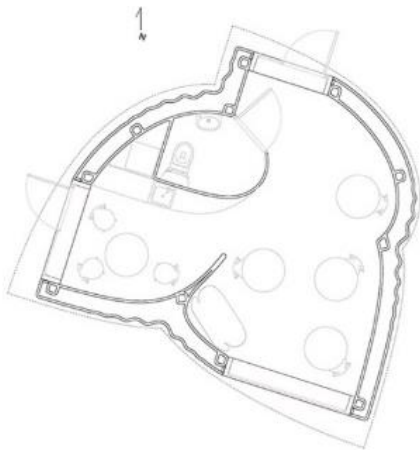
Planta de la casa B.O.D. COBOD. 2017
